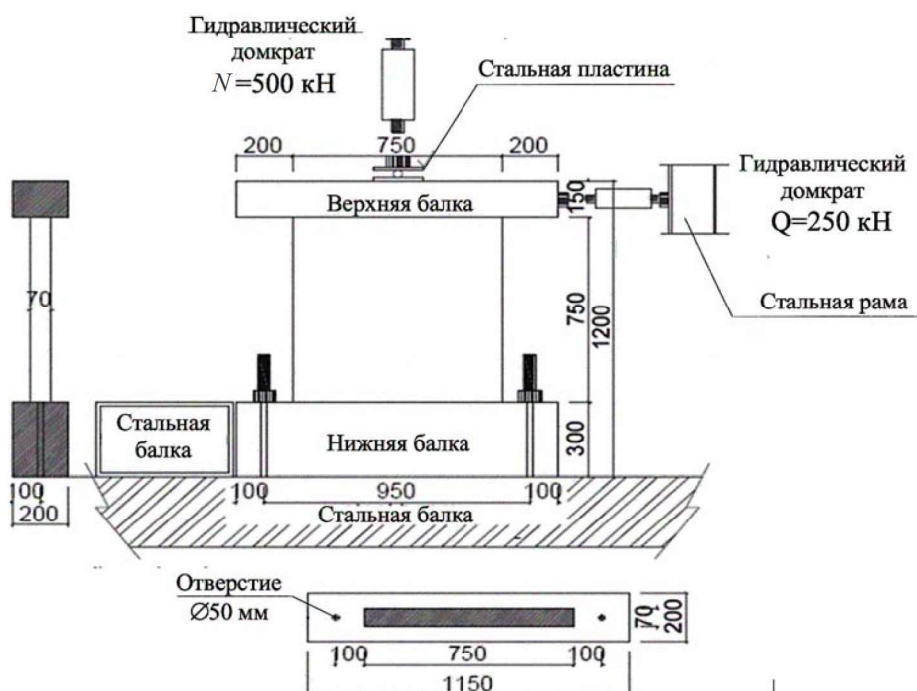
Схема экспериментальной установки для испытания железобетонной стены
